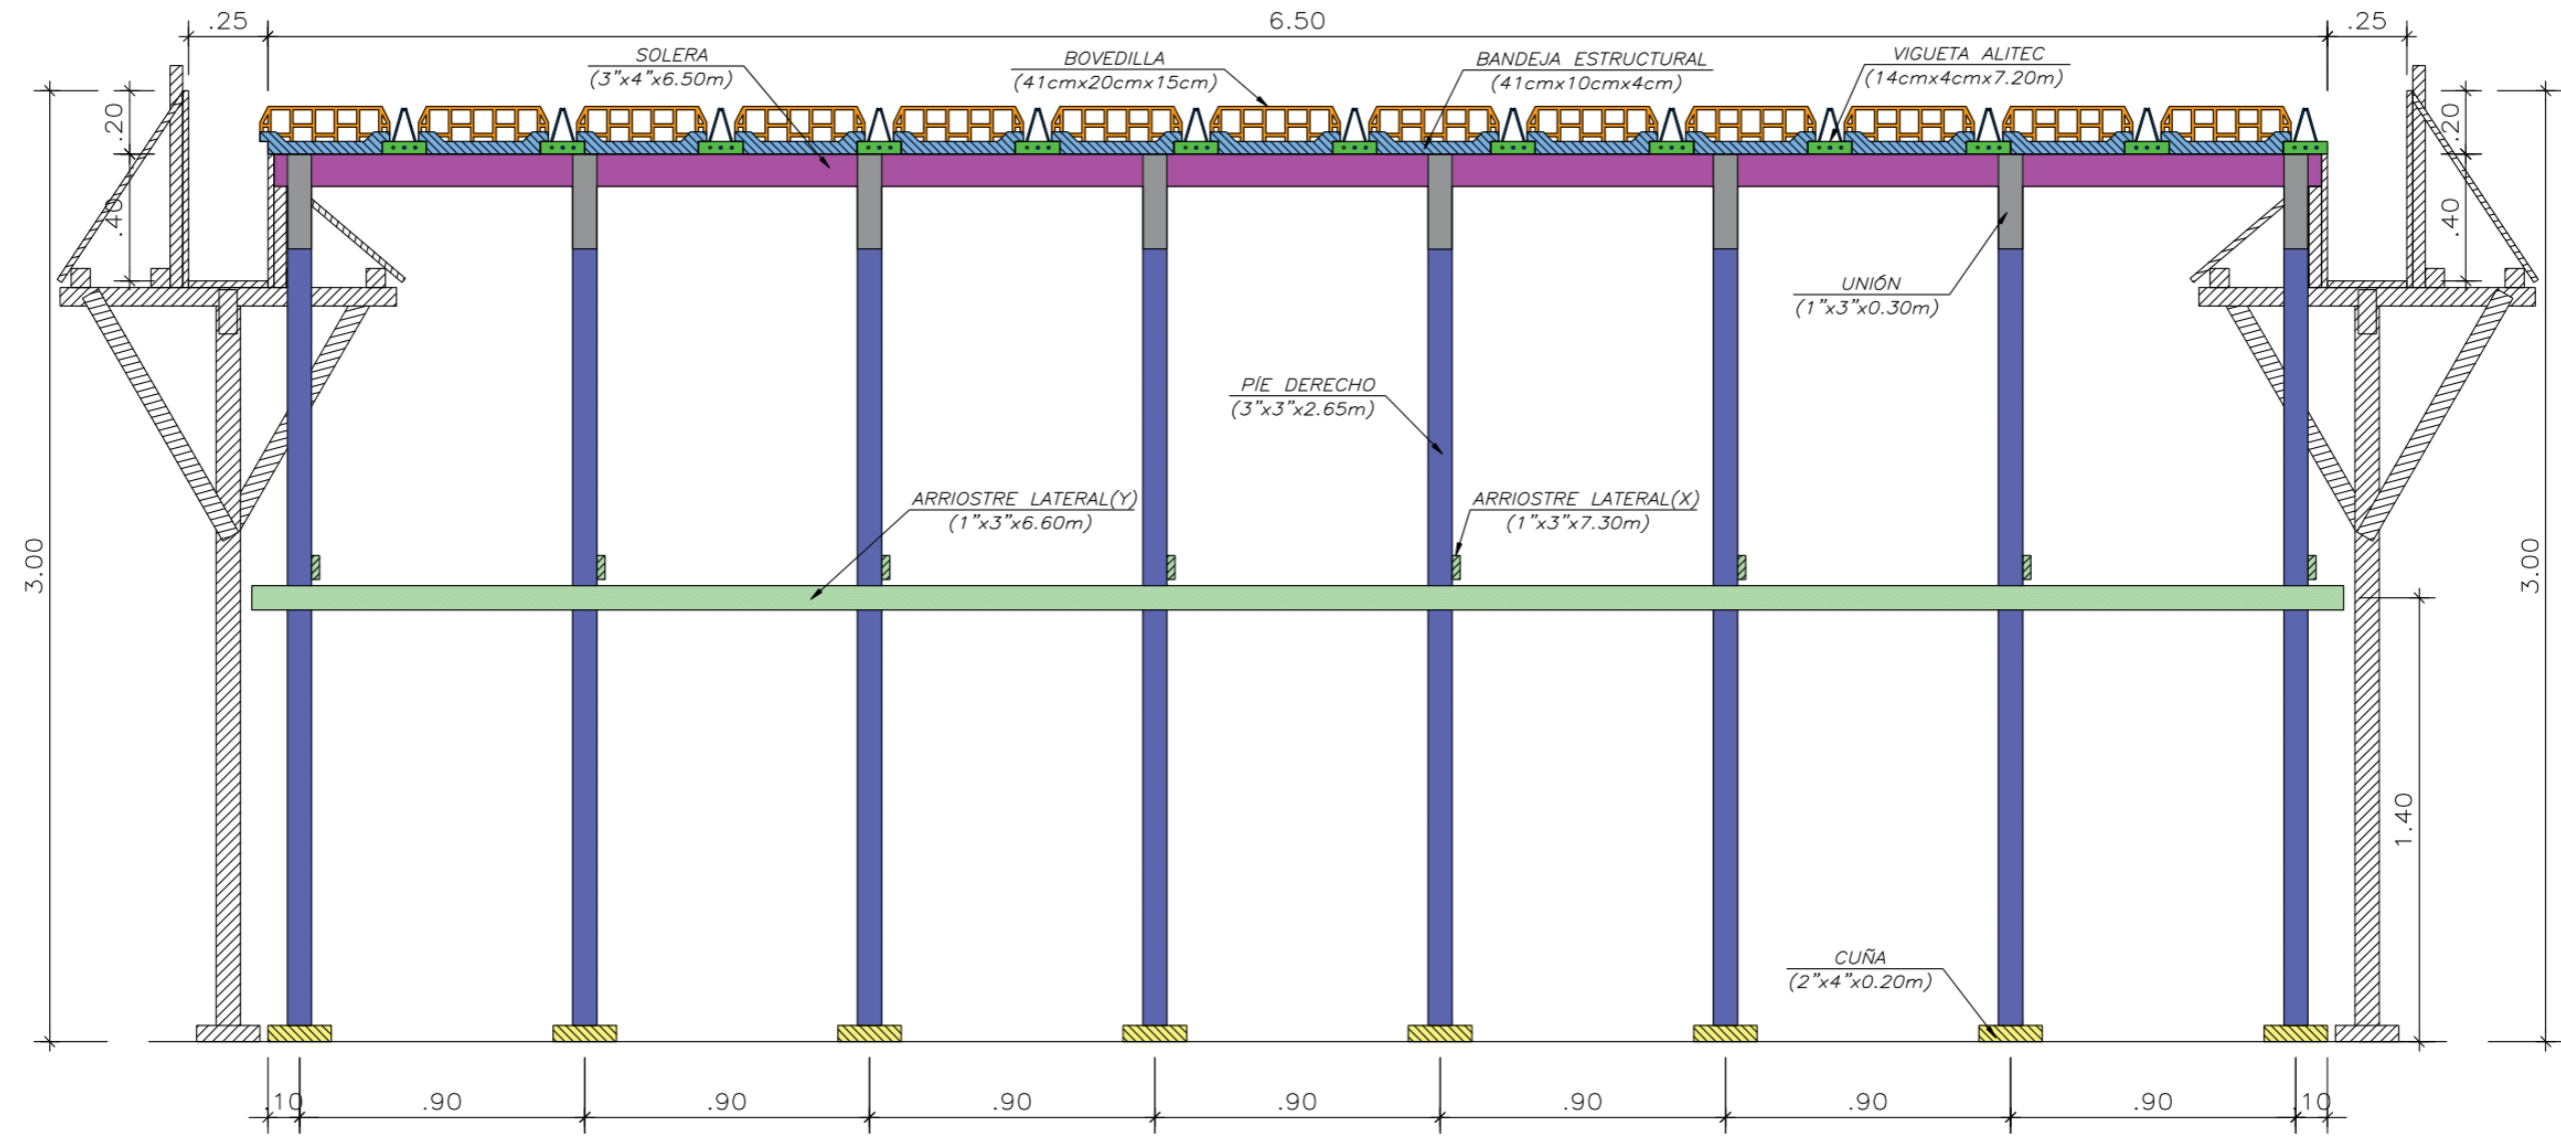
Corte Longitudinal D – D, para la Losa Aligerada Bidireccional Prefabricada Alitec.
